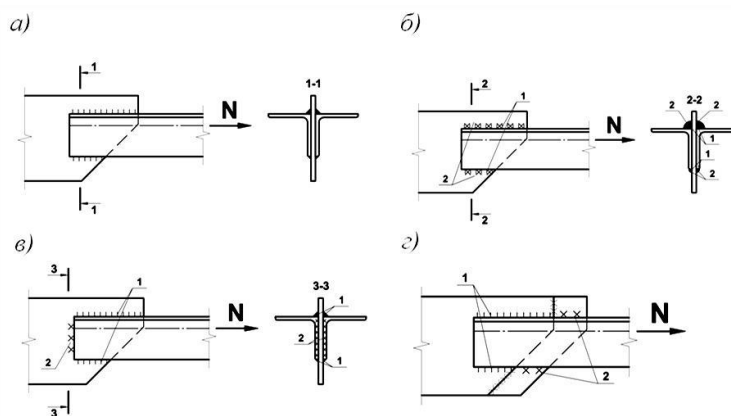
Способы усиления угловых сварных швов:
